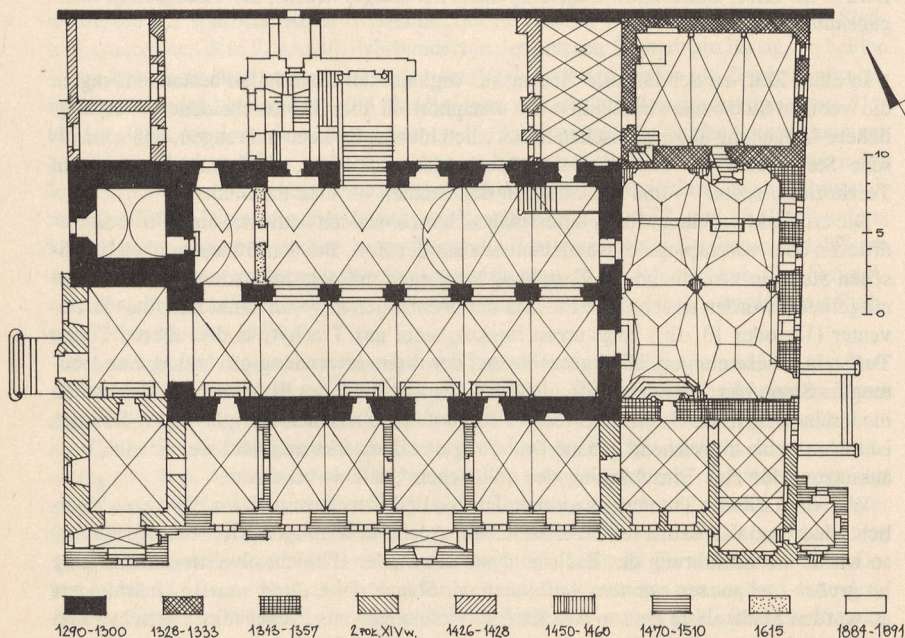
Breslau, Rathaus, Grundriß des Erdgeschosses mit Angabe der Bauphasen (Zlat)
